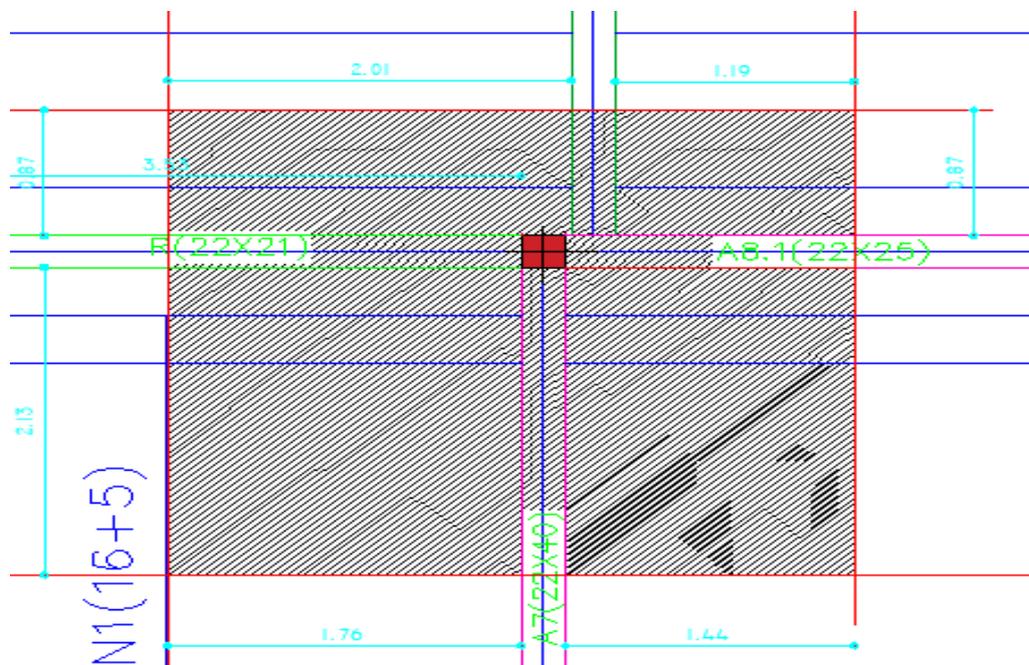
Descente de charge sur le poteau de plancher intermédiaire (1er étage)
